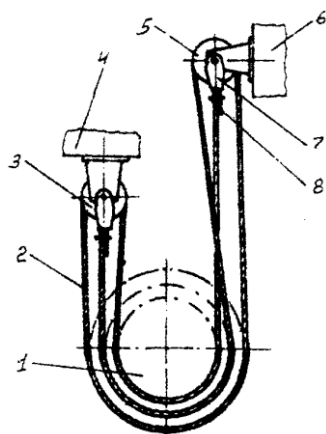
Схема запасовки и крепления компенсирующих канатов:
